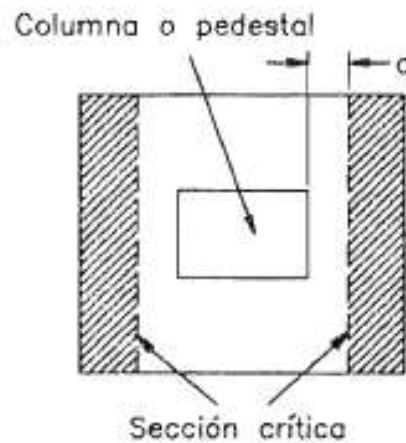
Sección crítica de corte por flexión en zapatas aisladas (Harmsen, 2002)
